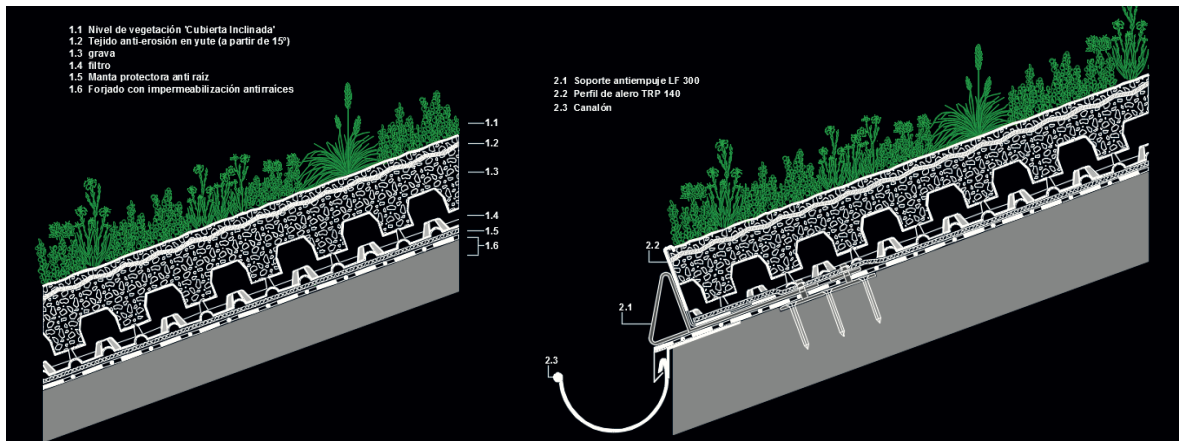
detalle de cubierta inclinada con manta protectora anti raíz
